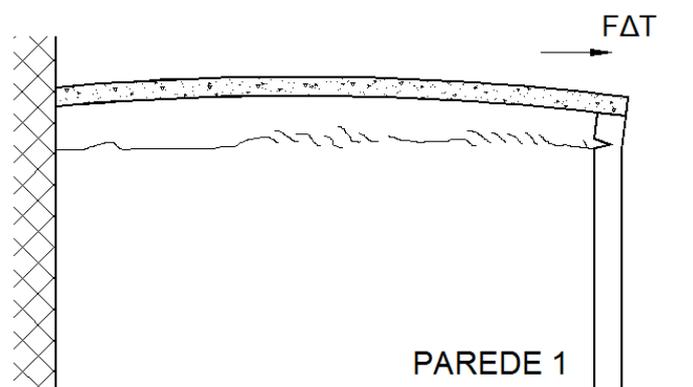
Fissuração da alvenaria em função da movimentação térmica (Fonte: VALLE, 2008)
